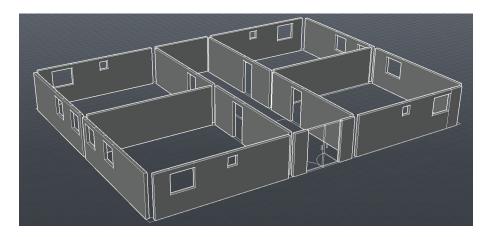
Posición de muros prefabricados en el primer piso. Fuente: Elaboración propia.
